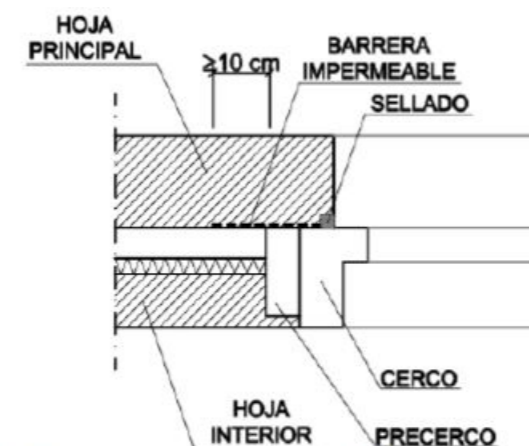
Ejemplo de encuentro de la fachada con la carpintería
